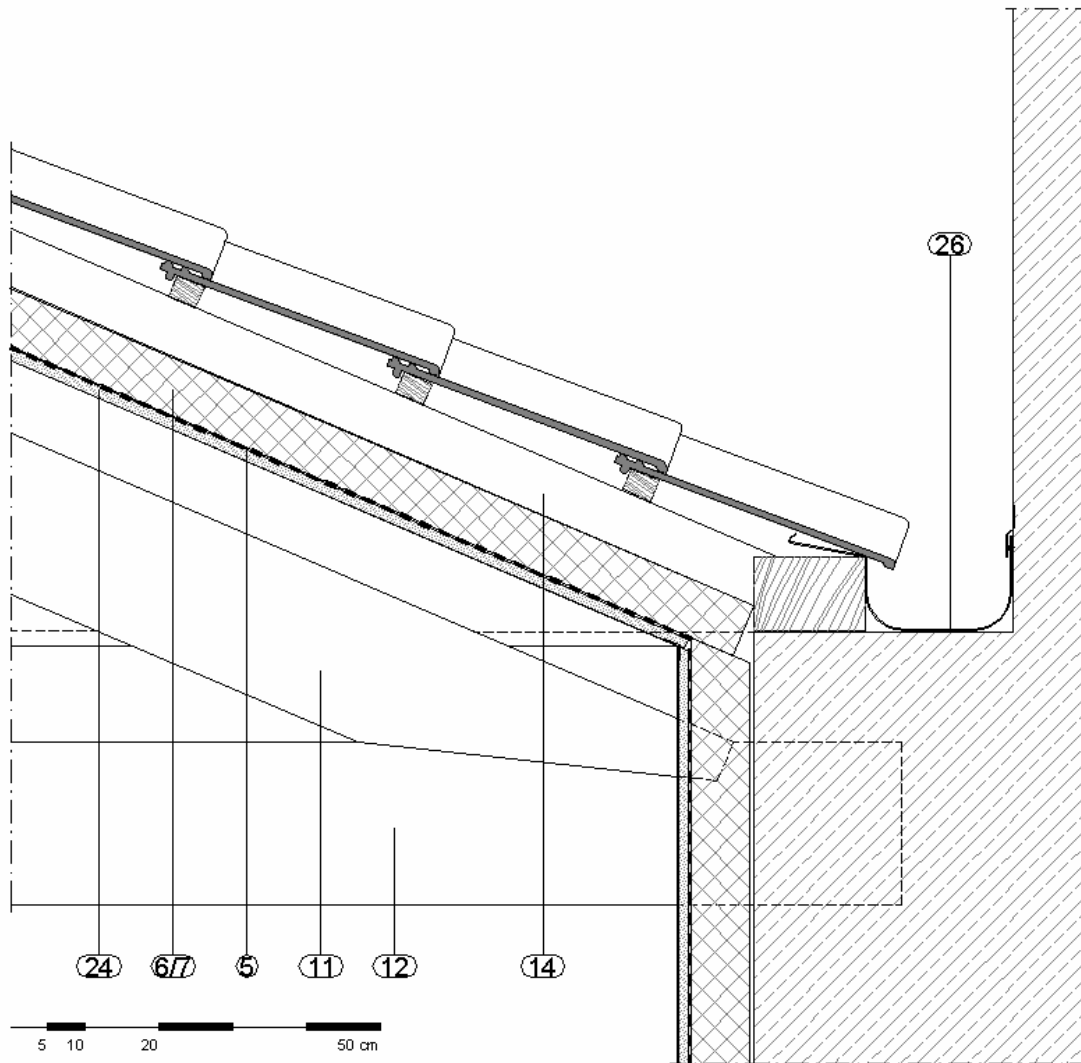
S5 – Pormenor na zona de ligação com empena.
